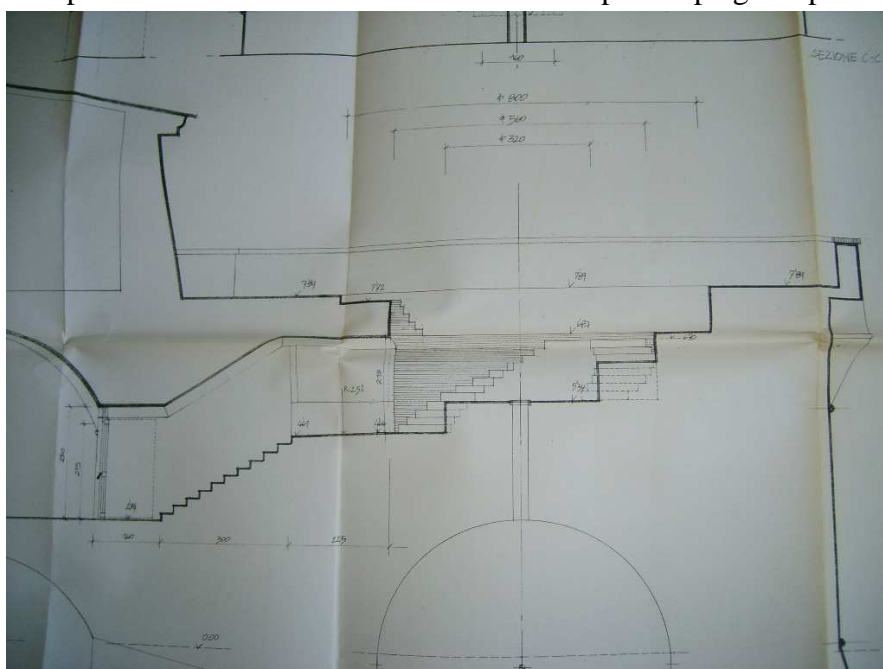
Variante progetto SPEA 1997 –sezione galleria torrione N/E (centrale)
